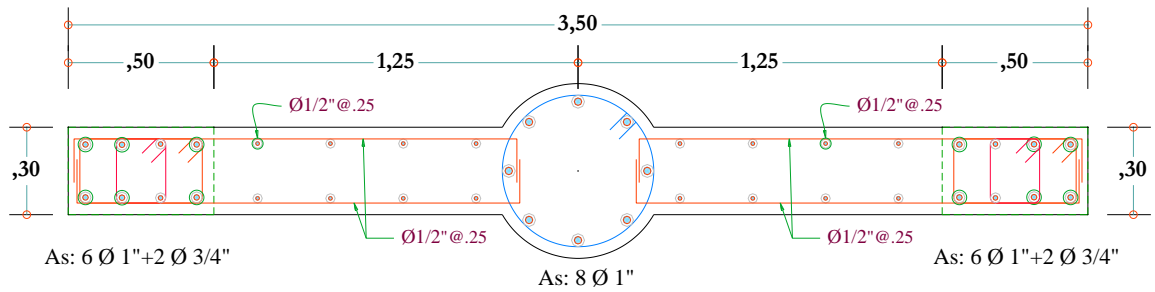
Diseño del acero vertical y núcleos confinados muro C-7
